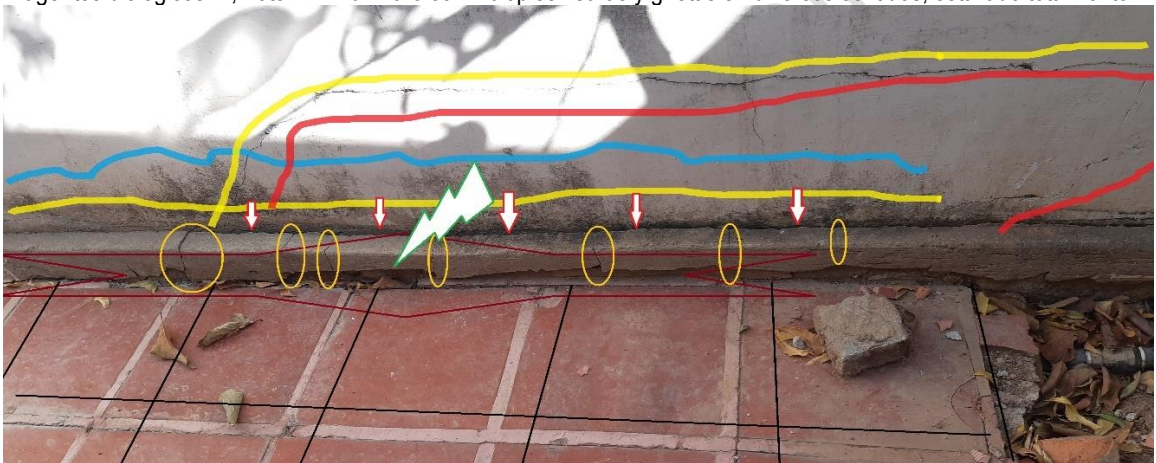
Estado actual, referencias de patologías, como: fisuras, grietas, fracturas de elementos estructurales y no estructurales, agrietamiento de pisos, presencia de humedades, entre otras.
